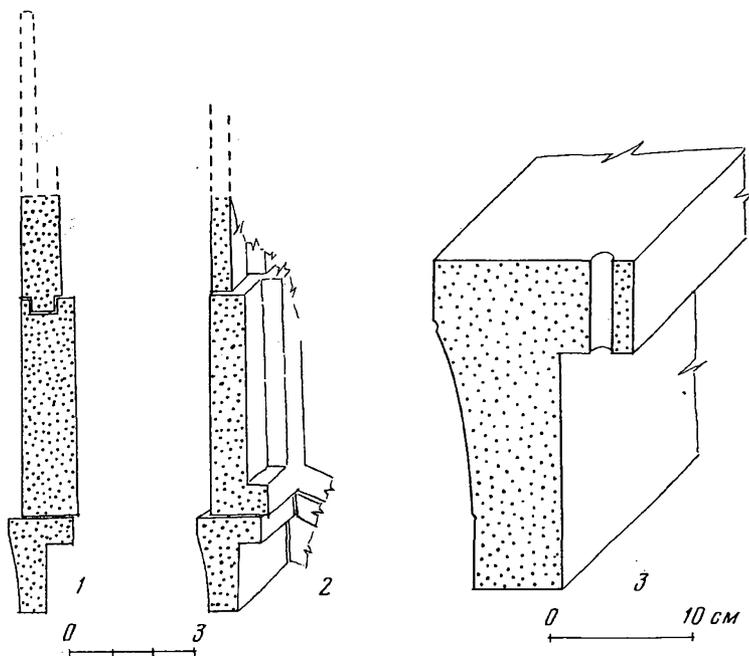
1, 2 – схема соединения карниза и частей акротерия: 1 – сечение по главной вертикальной оси акротерия; 2 – вертикальное сечение на расстоянии 15 см от главной вертикальной оси; 3 – поперечное сечение карниза
